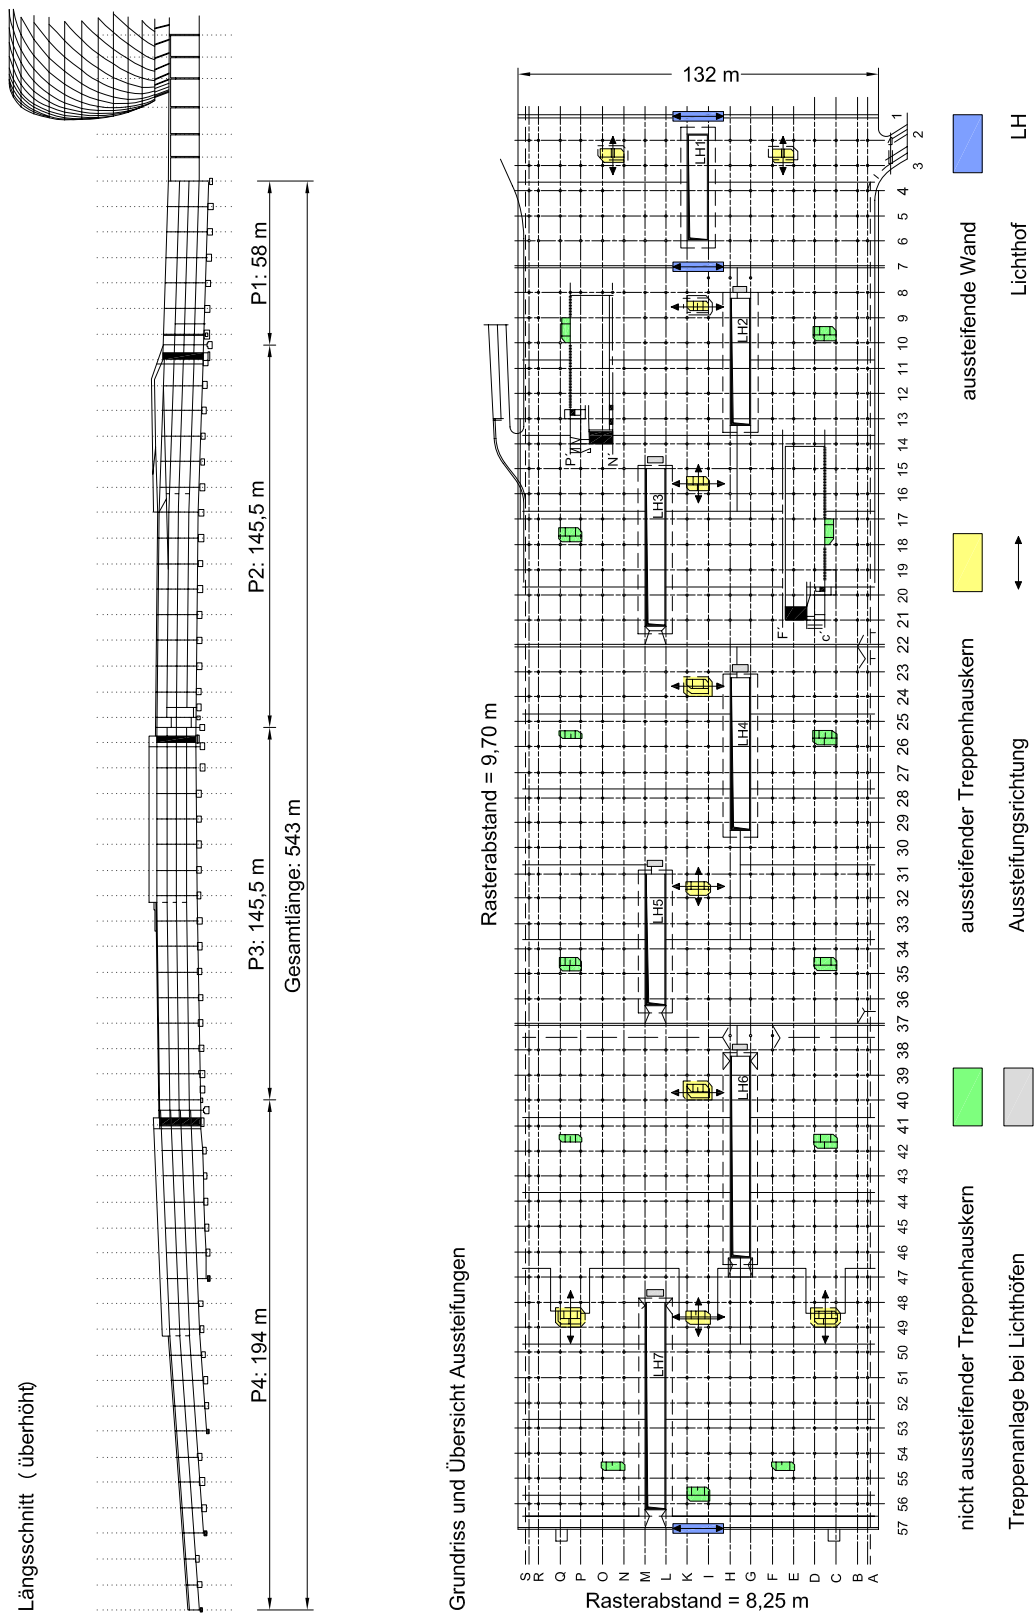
Grundriss des Parkhauses der Allianz-Arena München mit Übersicht der Aussteifungen und Schnitt [62]
